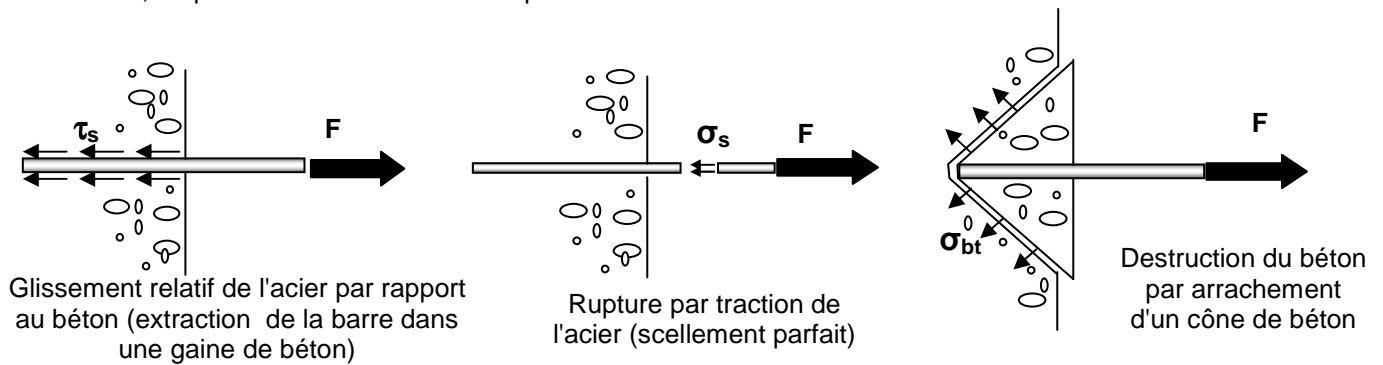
Essai d'arrachement d'une barre scellée dans un massif en béton
